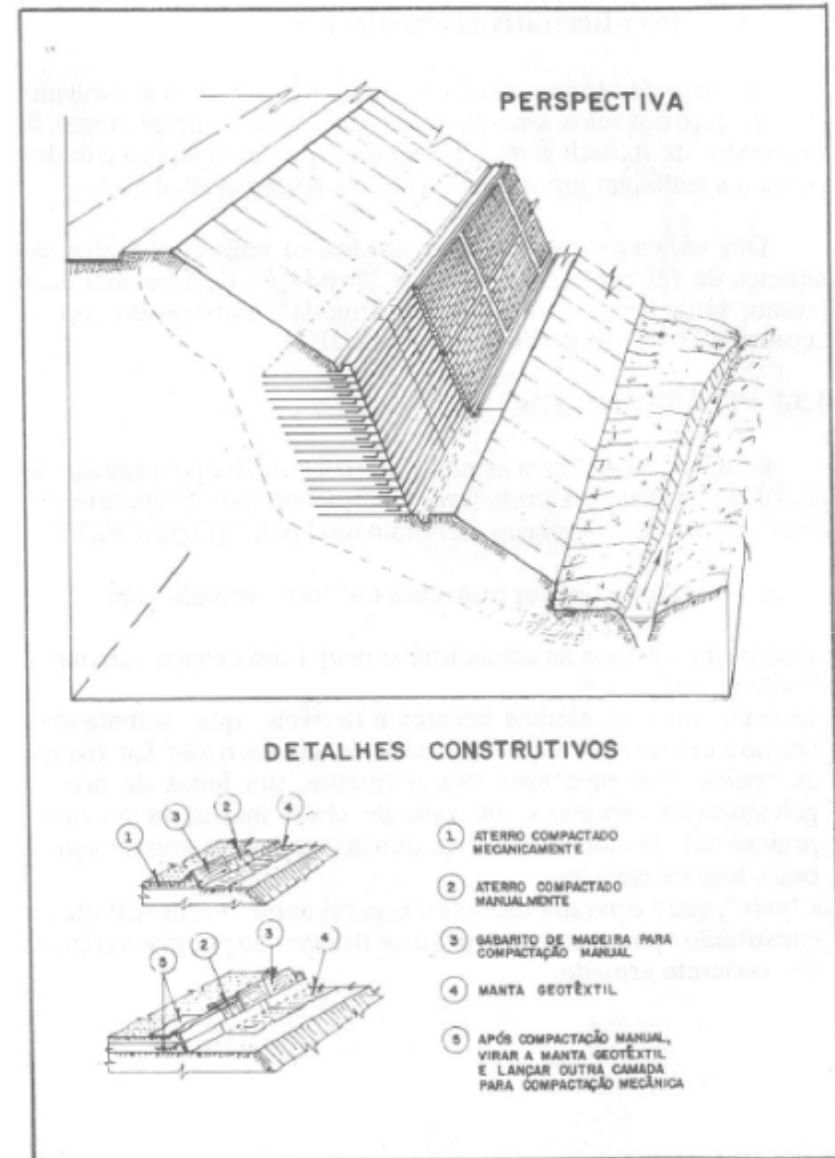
Exemplo de utilização de aterro reforçado com geotêxtil e detalhes construtivos
